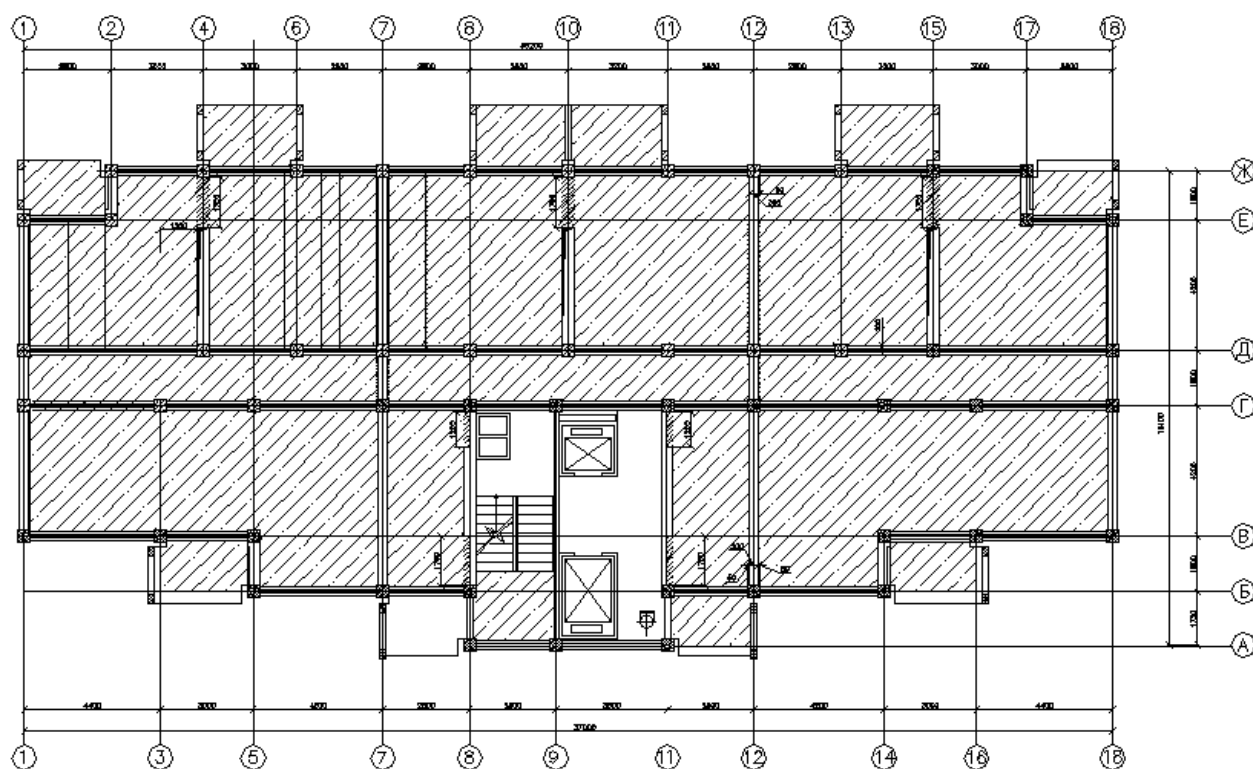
Сборно-монолитное железобетонное перекрытие
